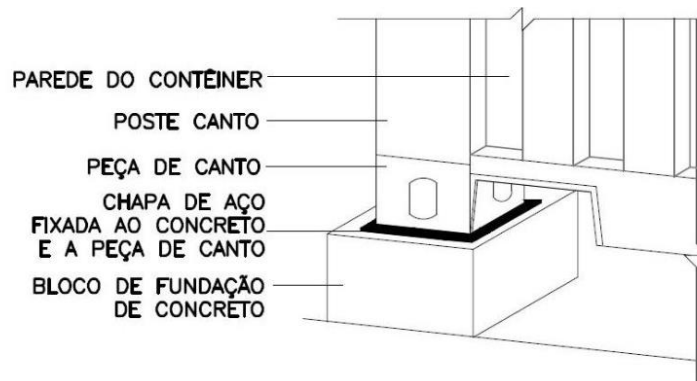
Casa container apoiada sobre sapatas isoladas.
